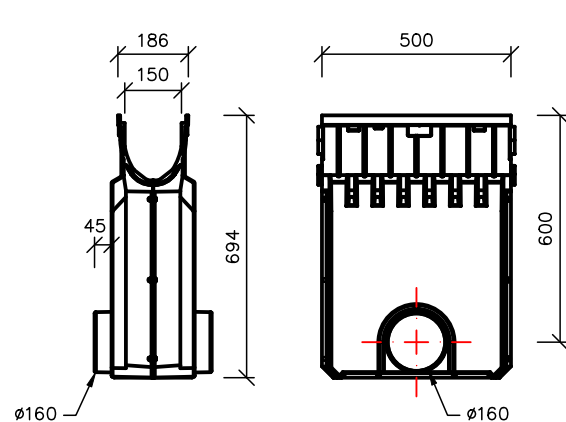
DETAIL ULOŽENÍ ŽLABŮ MEA KERB
